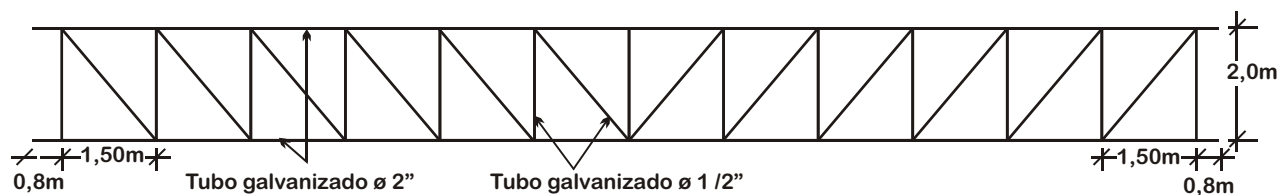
Cercha para el apoyo de tableros en señales elevadas tipo pasavías
